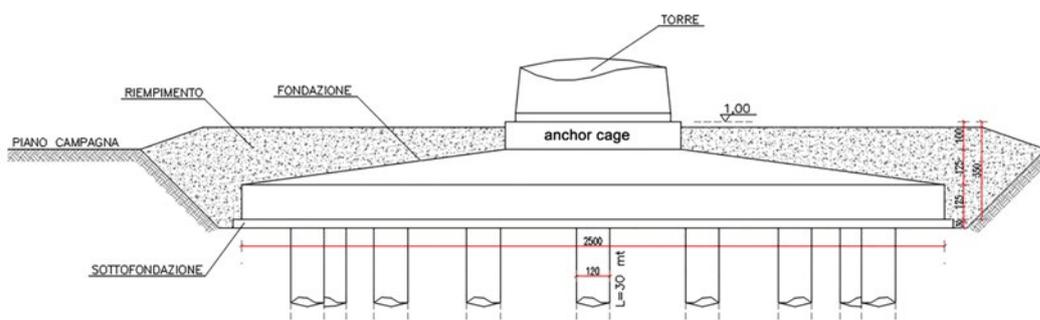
Dettaglio tipo plinto di fondazione aerogeneratore
